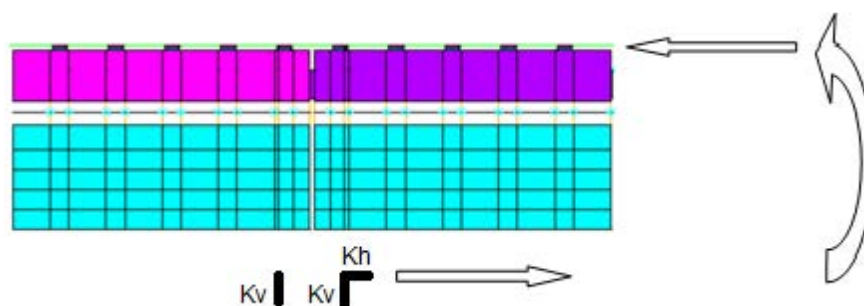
Binário entre a via-férrea e a restrição horizontal do apoio
